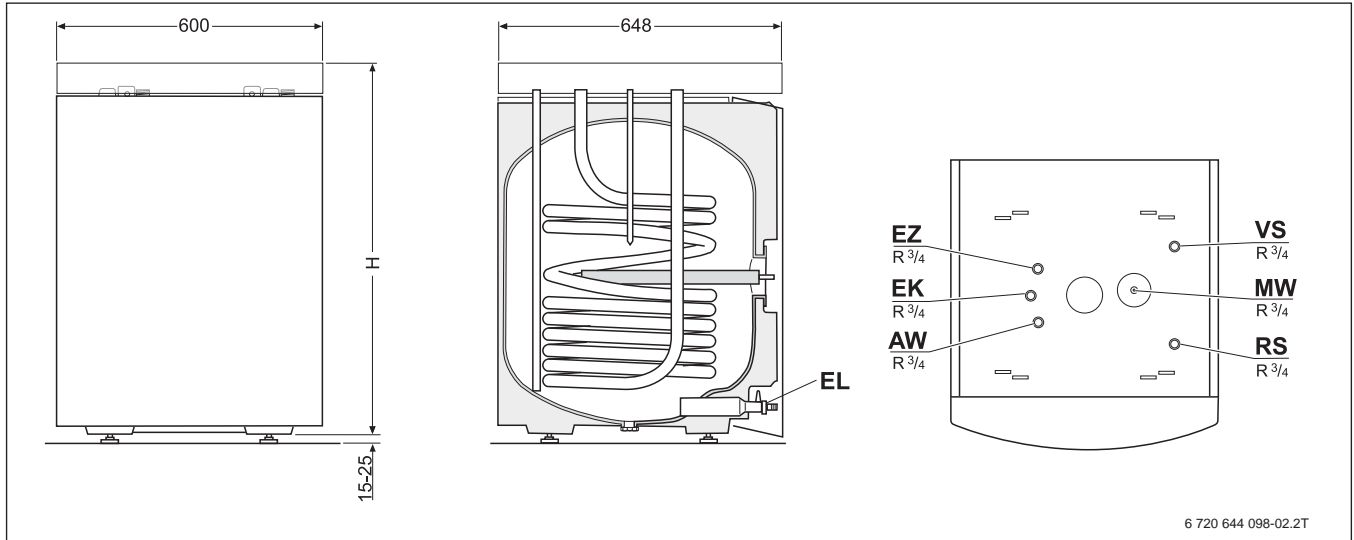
Abmessungen und Anschlüsse (Maße in mm)
